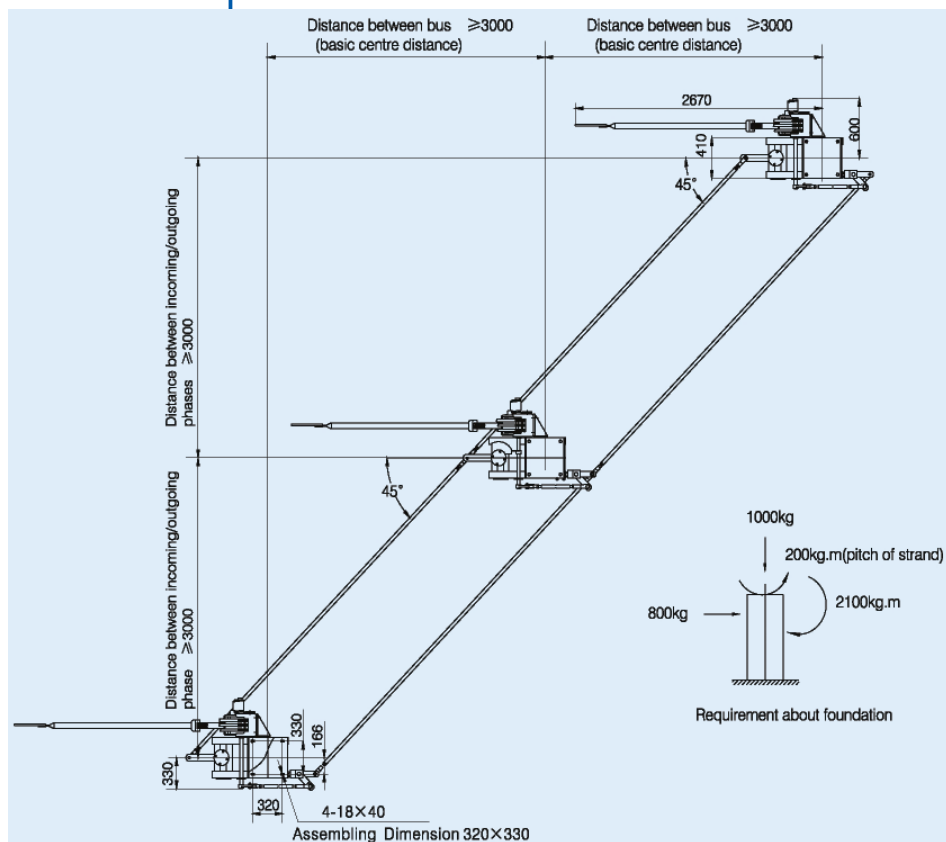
Внешний вид и размеры разъединителя GW22-252
